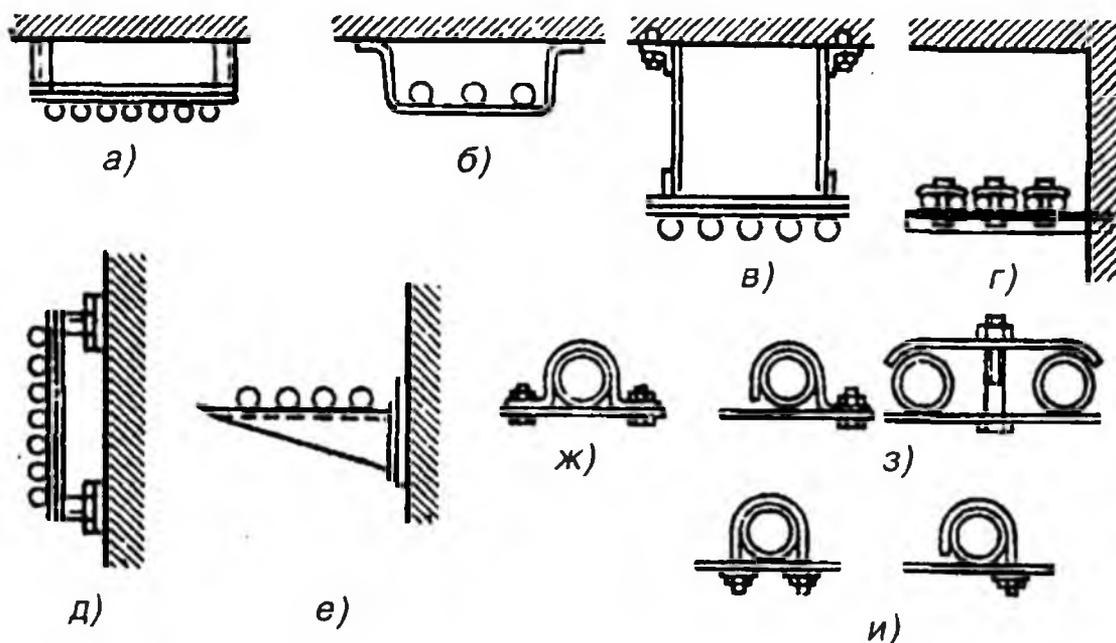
Способы крепления труб к опорным конструкциям:
